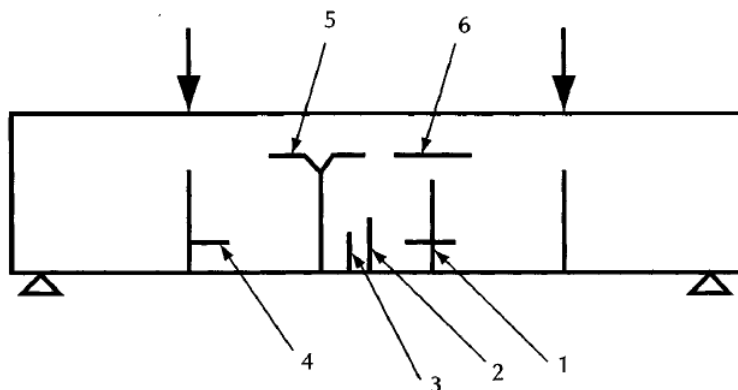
Configuración de agrietamiento de una viga sujeta a flexión simple [18]
